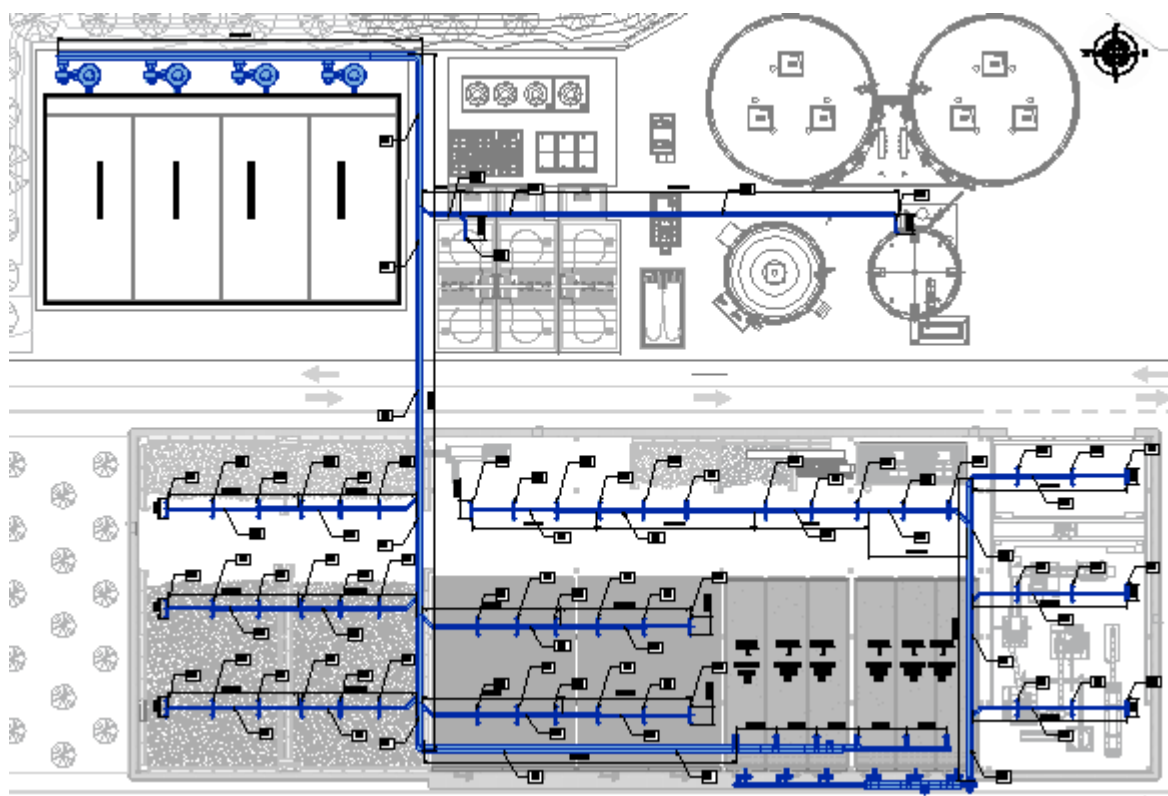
Planimetria rete aspirazione e ricircolo aria
